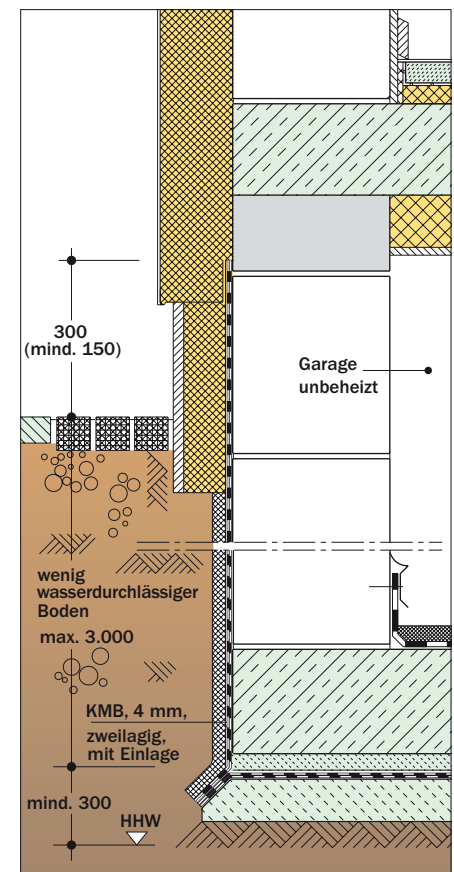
Abdichtung gegen stauendes Sickerwasser mit KMB
